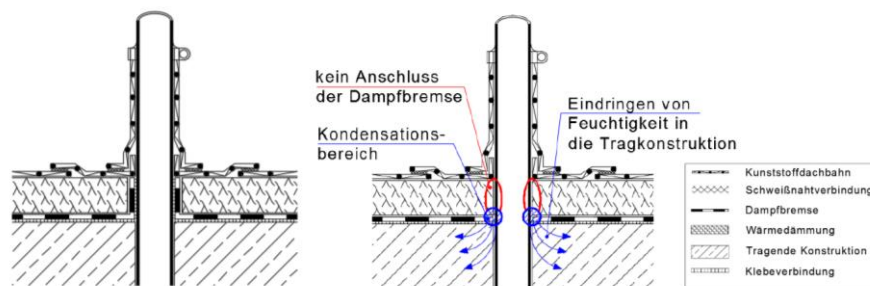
Fachgerechte Ausführung (links) und mangelhafte Ausführung (rechts) von Rohrdurchführungen durch ein Flachdach<sup>60</sup>
